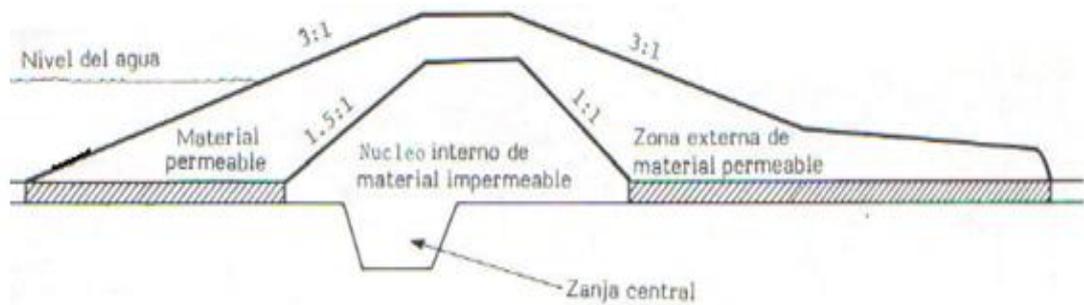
Dique construido en una zona de suelo permeable y hecho con un núcleo con materiales impermeables de otro sitio. Fuente: FAO
